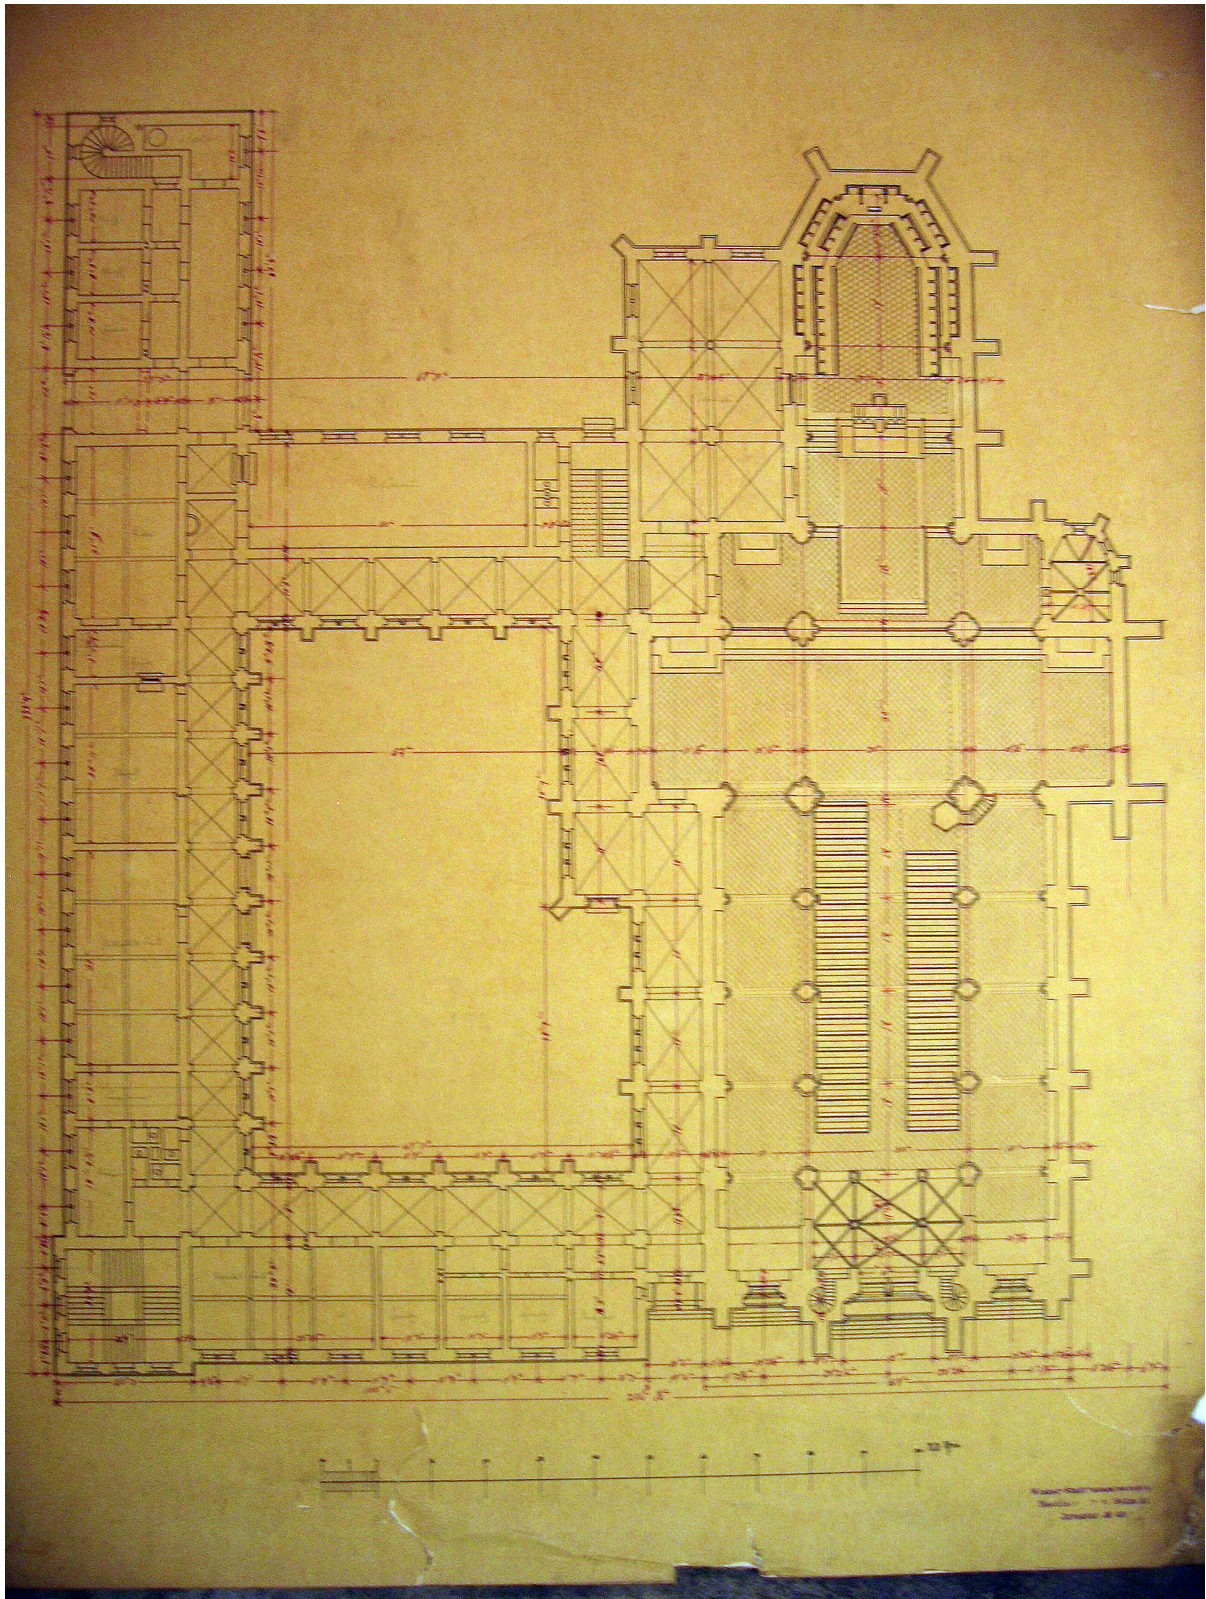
WM, Inv.-Nr. 157.43/11 dritter Entwurf, Grundriss in Sockelhöhe
